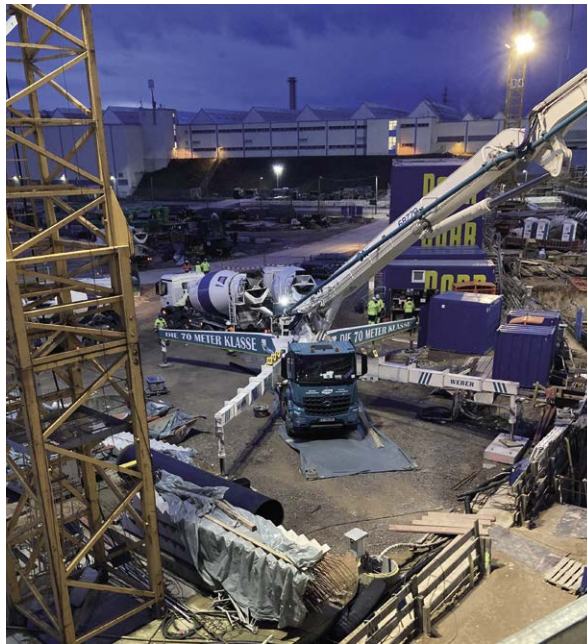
Die Fotos auf der Baustelle FAIR entstanden bei einer 24-stündigen Betonage mit 400 m³ Selbstverdichtendem Beton am Abend des 12. März 2021 bei stürmischem Wetter. Den Beton lieferte in diesem Fall die Profi Beton GmbH, gefördert wurde er mit einer 70-Meter-Mast-Autobetonpumpe.
